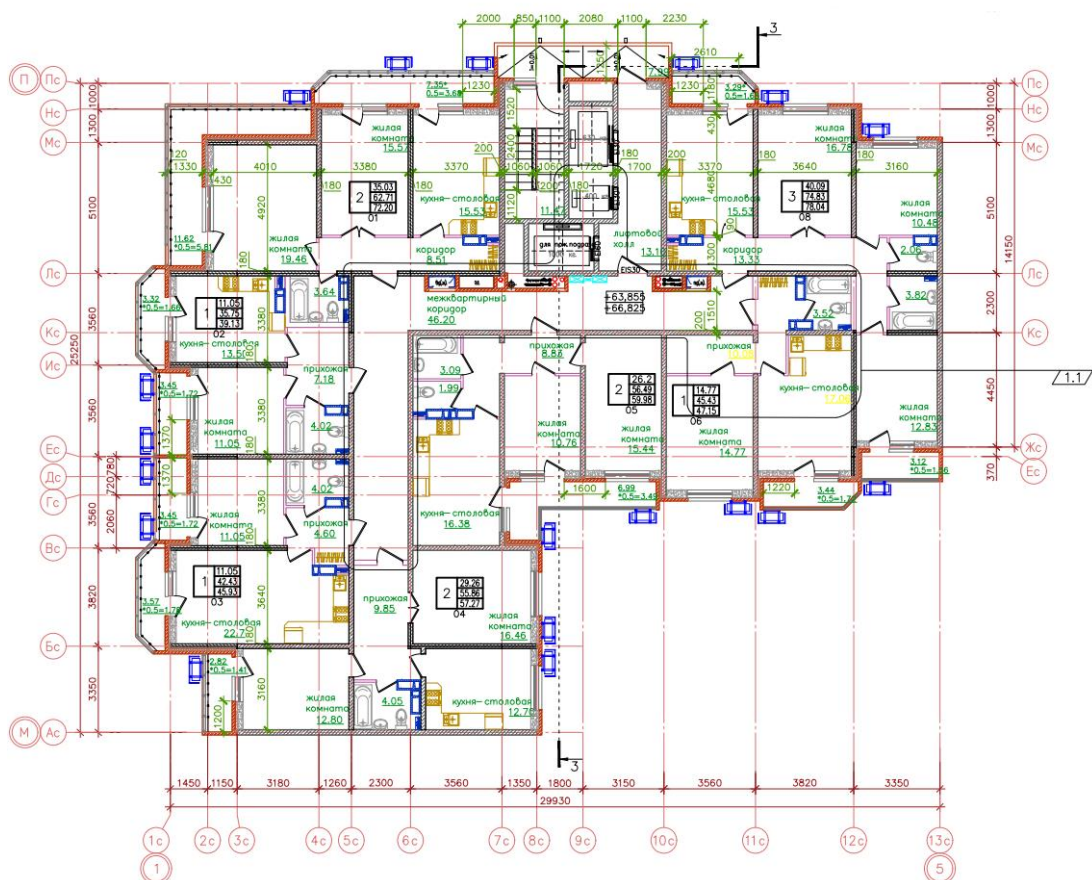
Типовой план 22-23 этажа БС-5 ЖК URAL
